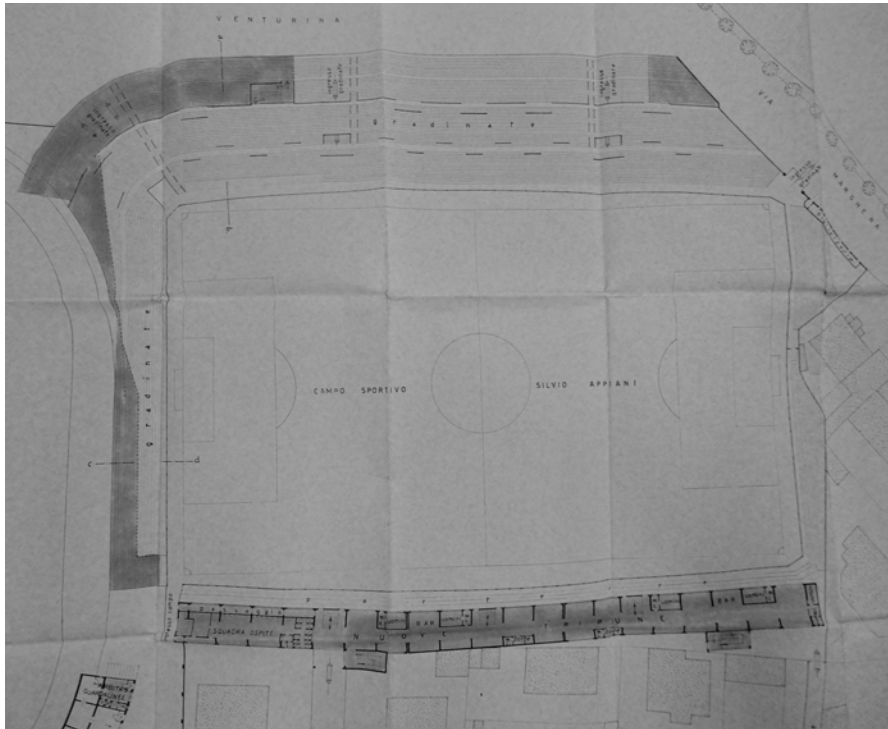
Pianta del progetto di massima con evidenziate le porzioni oggetto di intervento.
